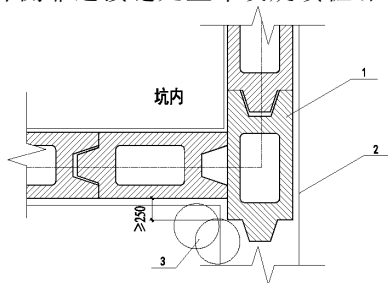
基坑平面转折或多墙交接处预制墙板连接构造图
